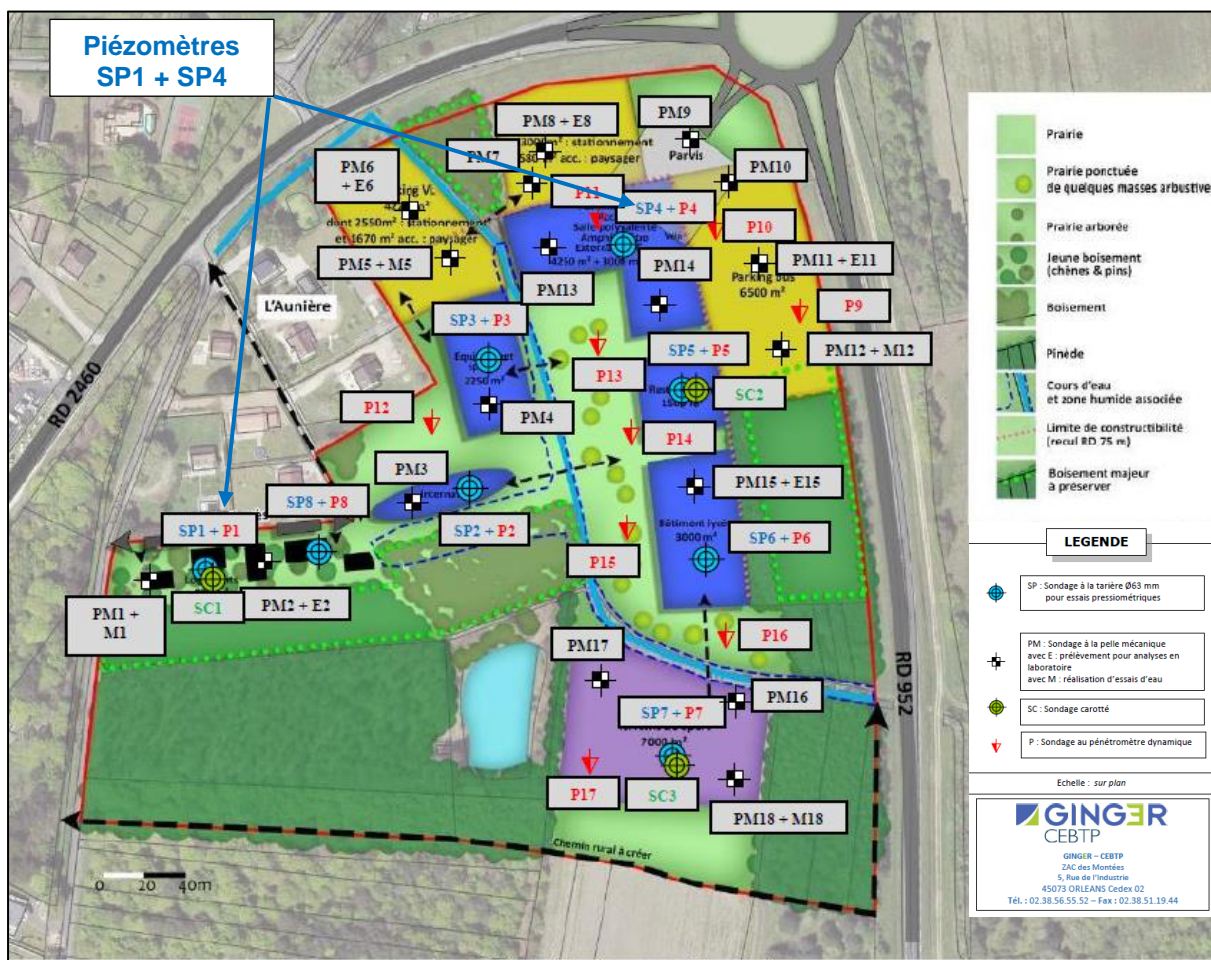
Plan d'implantation des sondages (Extrait du rapport géotechnique de GINGER CEBTP - Février 2020)
